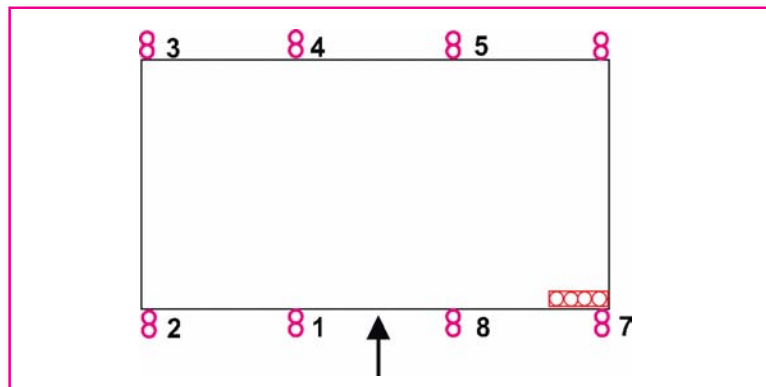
Ein Schulgebäude mit einer Fangeinrichtung, acht Ableitungen, acht Erdeinführungen und einer PAS
